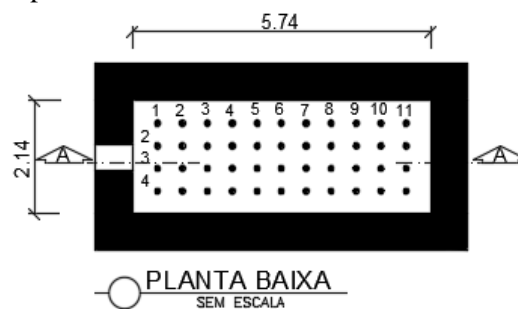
Planta baixa esquemática com pontos em malha para cálculo das UDI.
